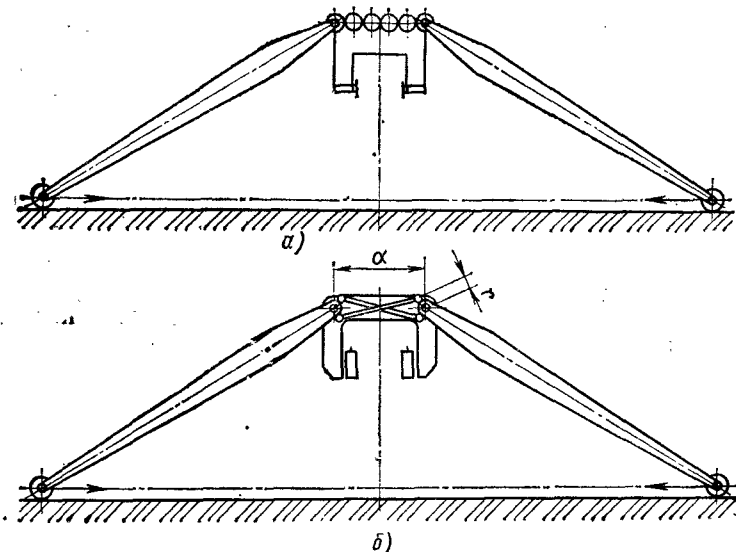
Схема самоподъема козловых кранов: а — с зубчатыми колесами; б — с перекрещивающимися рычагами
